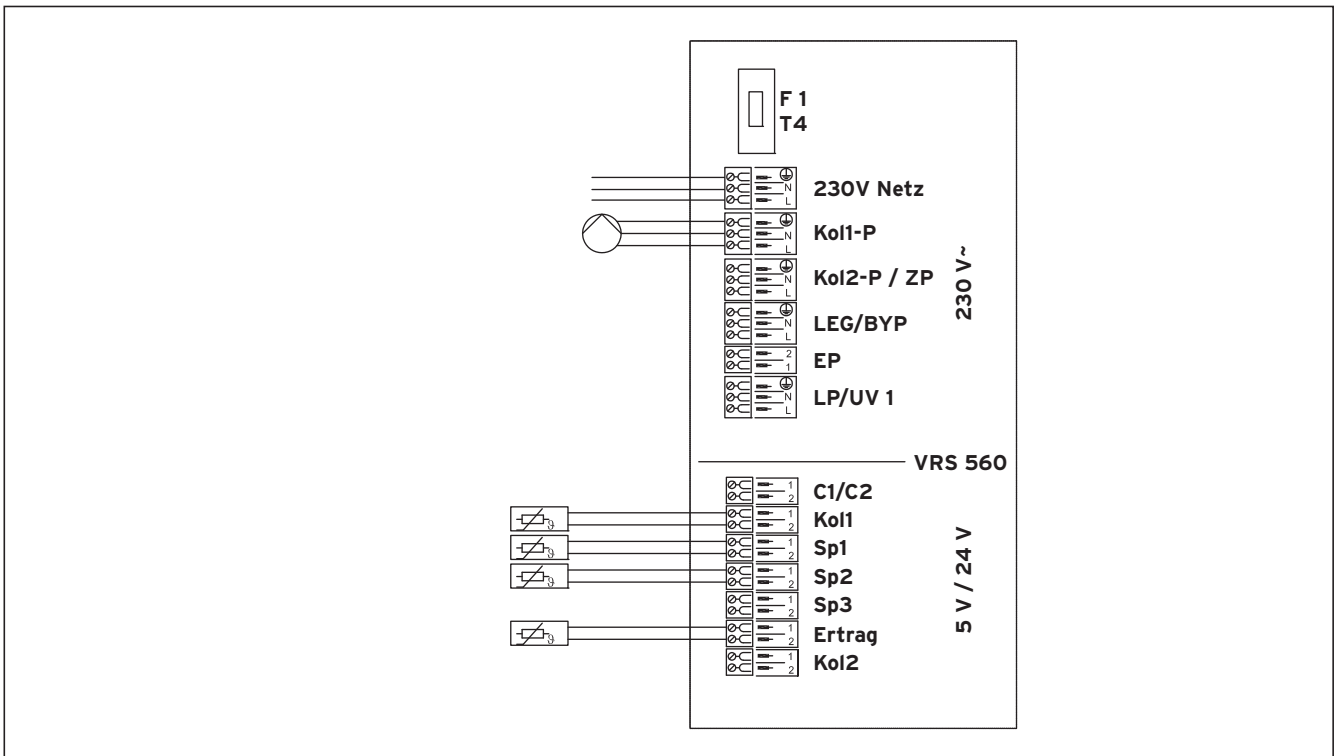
Plan de raccordement pour schéma hydraulique 1 :
